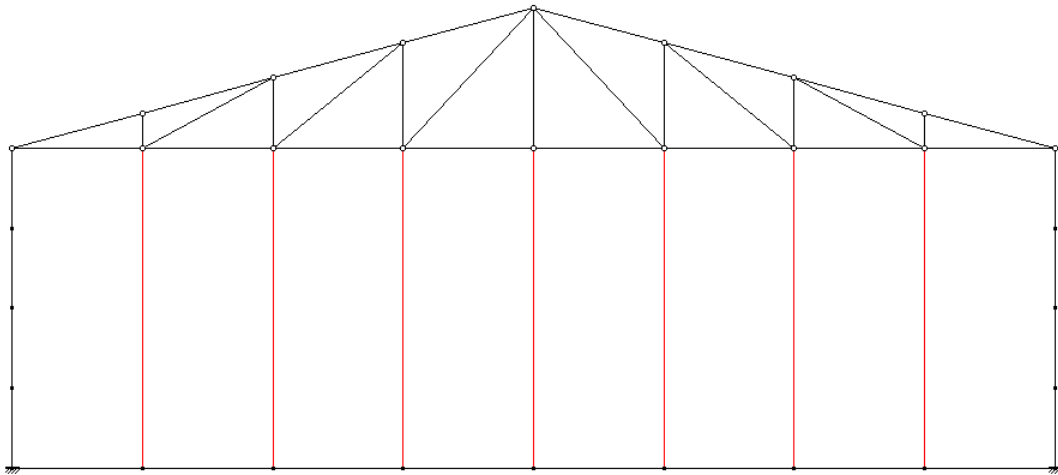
Representação dos pilares de empena (a vermelho) na fachada de empena.
